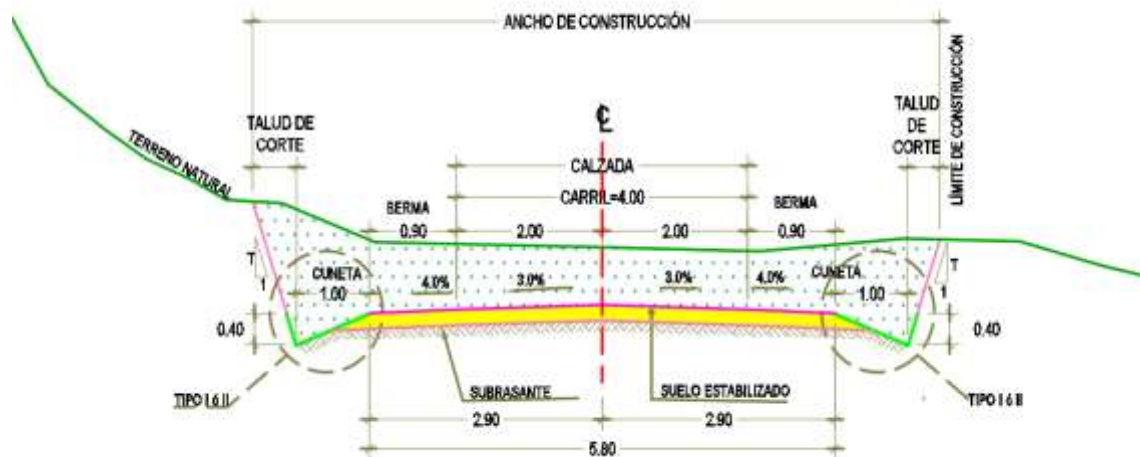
Sección típica en corte cerrado. Fuente: Planos Secciones Típicas
